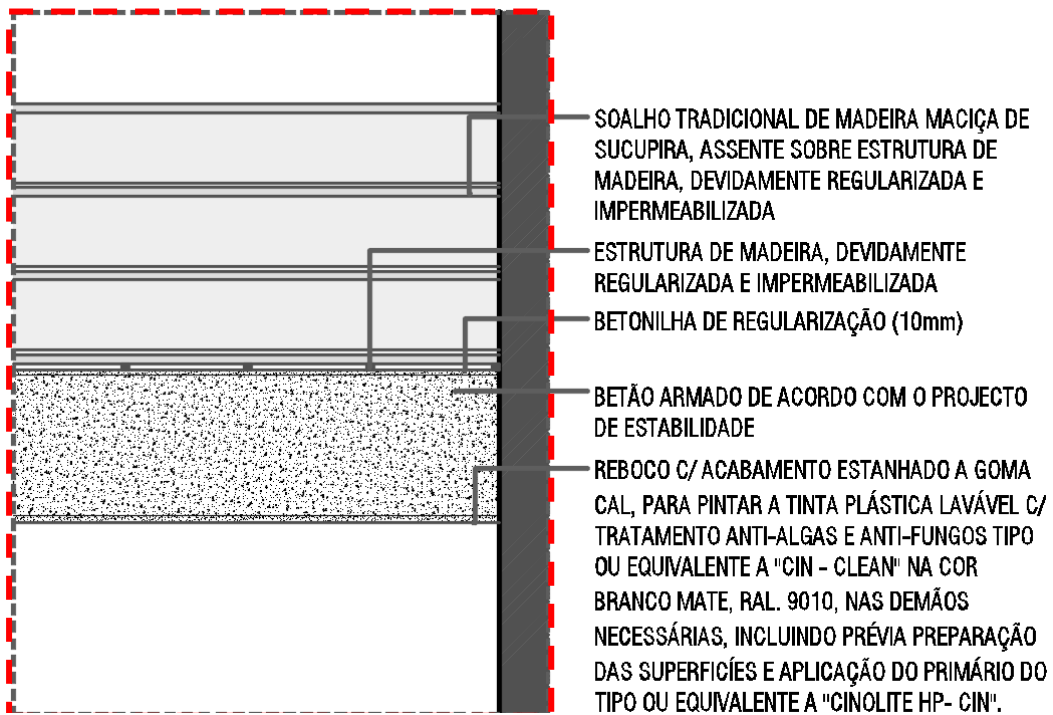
Pormenor construtivo e legenda da escada de acesso ao piso 03
